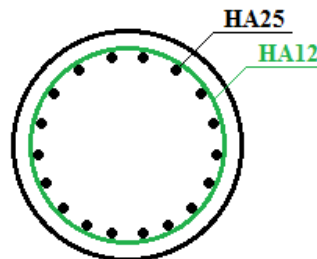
Ferrailage d'un pieu sous culée.
